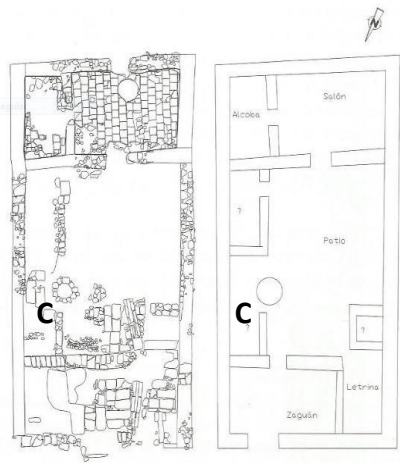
(izda.): Huerta de Santa Isabel. Casa 101. Planta y distribución de espacios.
